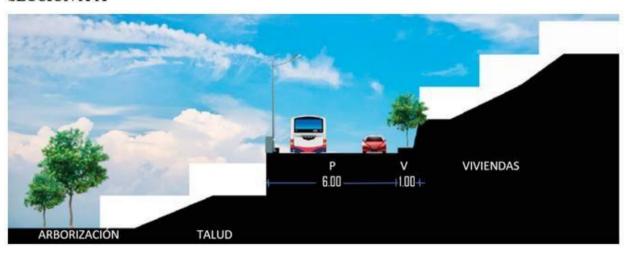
Plano estado actual de vías (Villa el Triunfo).
